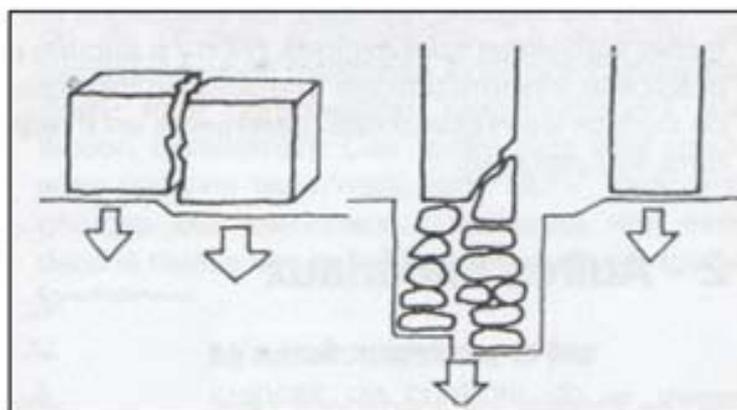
tassement différentiel engendrant la déstabilisation de la fondation. Source : auteur
